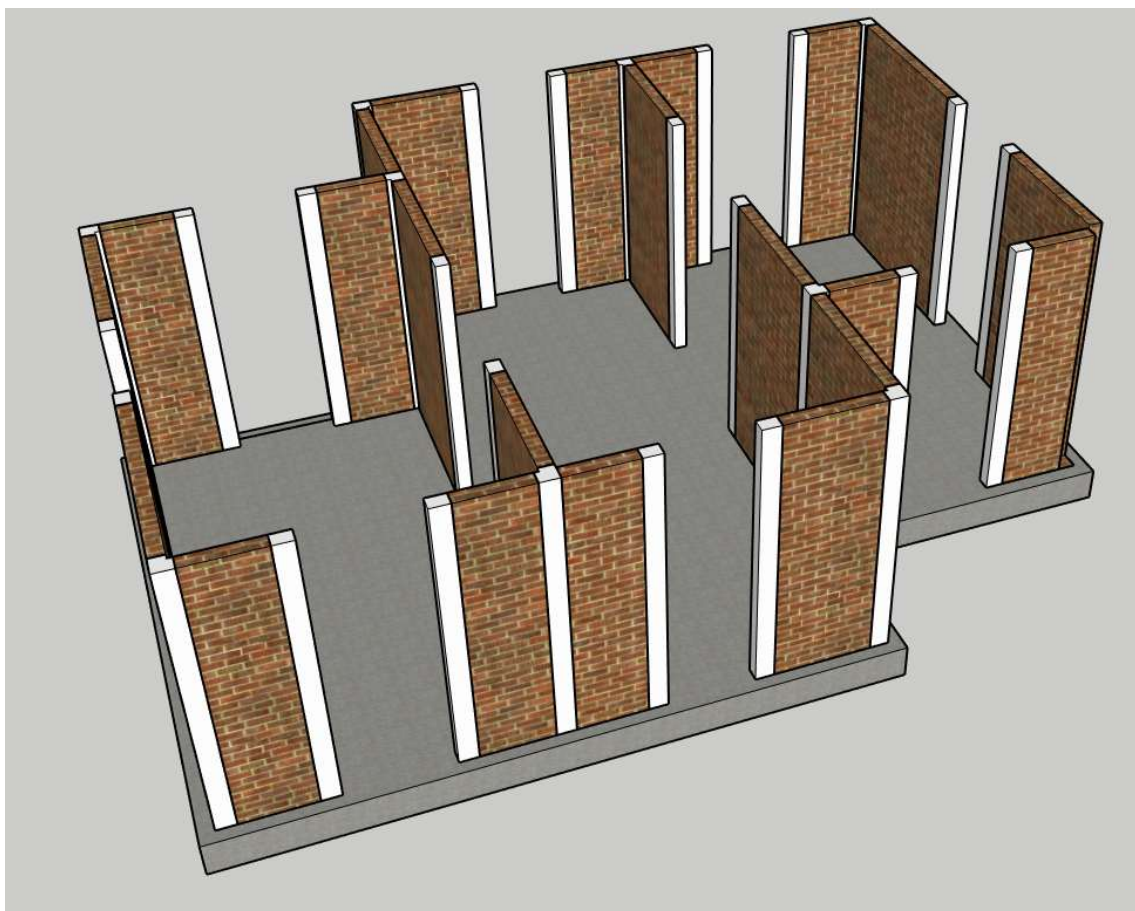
Vista de los muros confinados antes de fundir las columnas de confinamiento
